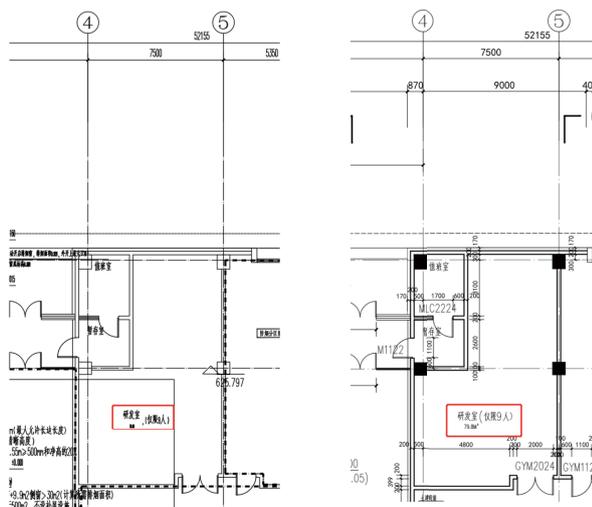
A3-2实验室首层平面截图(左侧为排烟平面,右侧为建筑平面)
